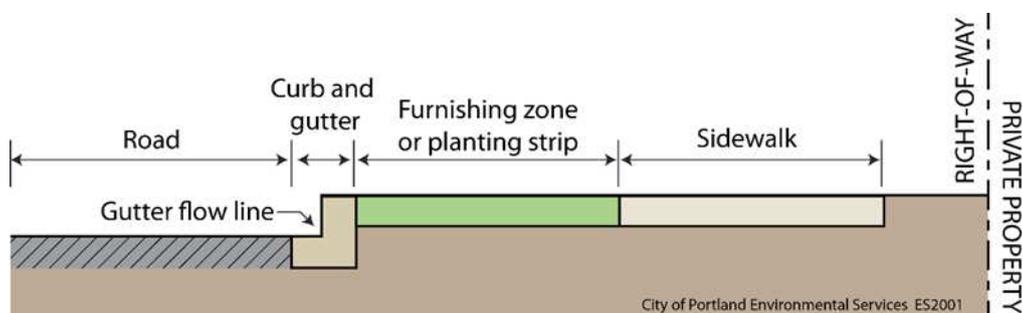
Sezione di una strada verde. Fonte: Storm Water Management (SWMM)
